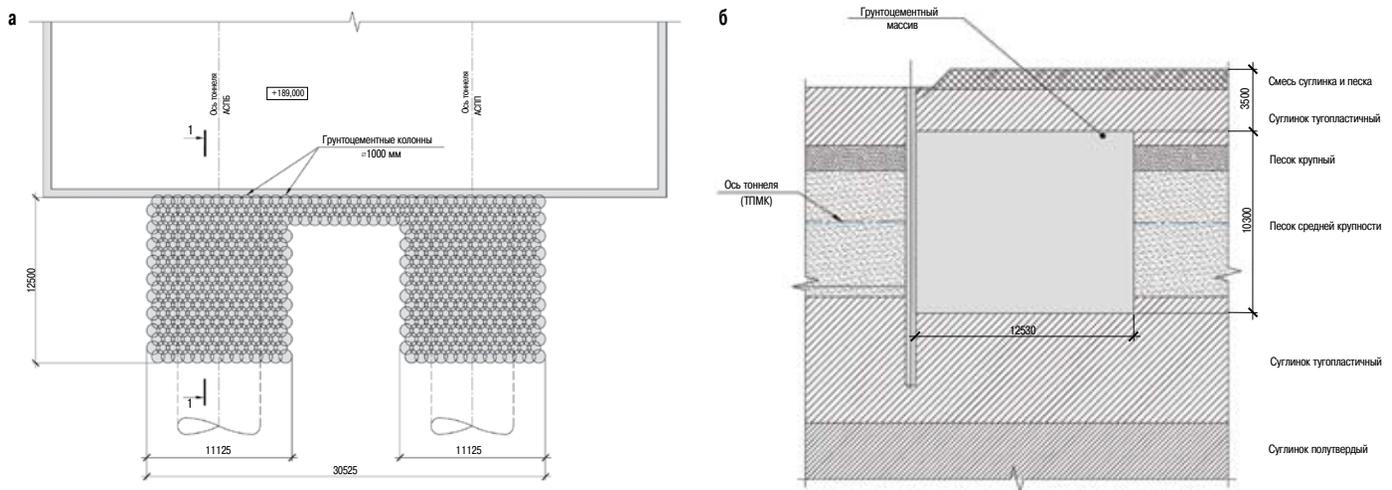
План (а) и разрез (б) пригруза тоннеля в зоне стартового котлована
